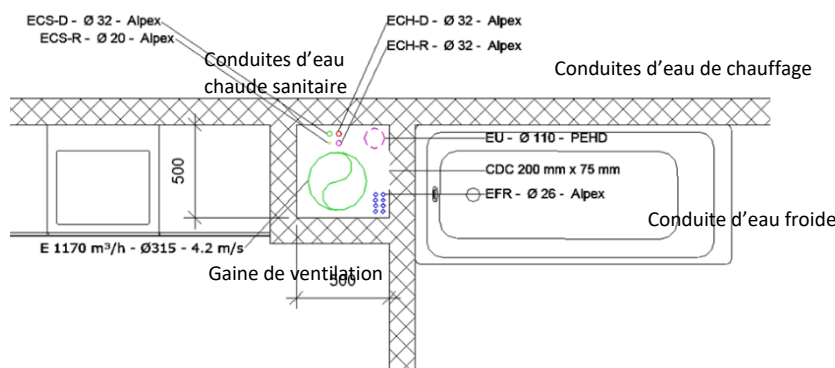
Exemple de conduites d'air et d'eau dans une trémie technique sur un plan technique
